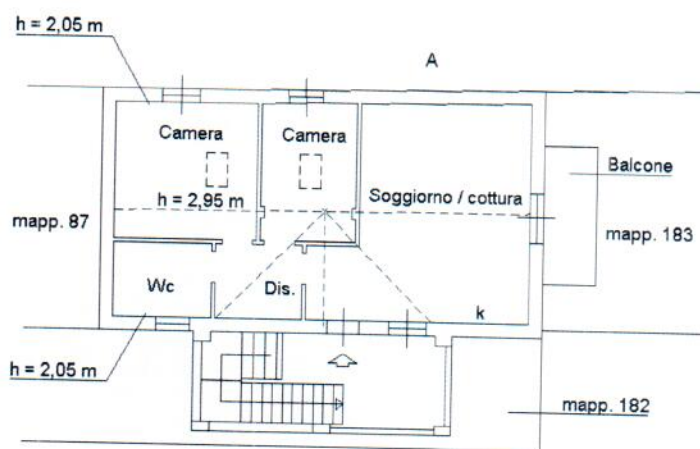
planimetria catastale del 19/11/2013 - stato attuale
